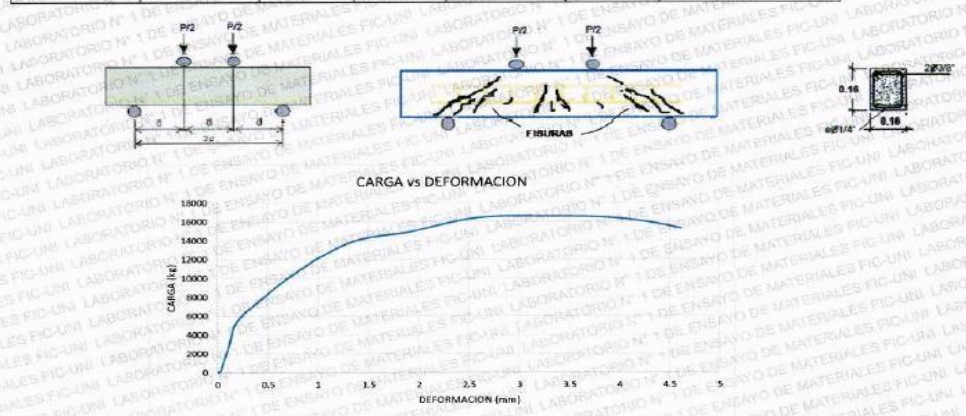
Carga máxima en flexión para viga 6 de concreto armado.
